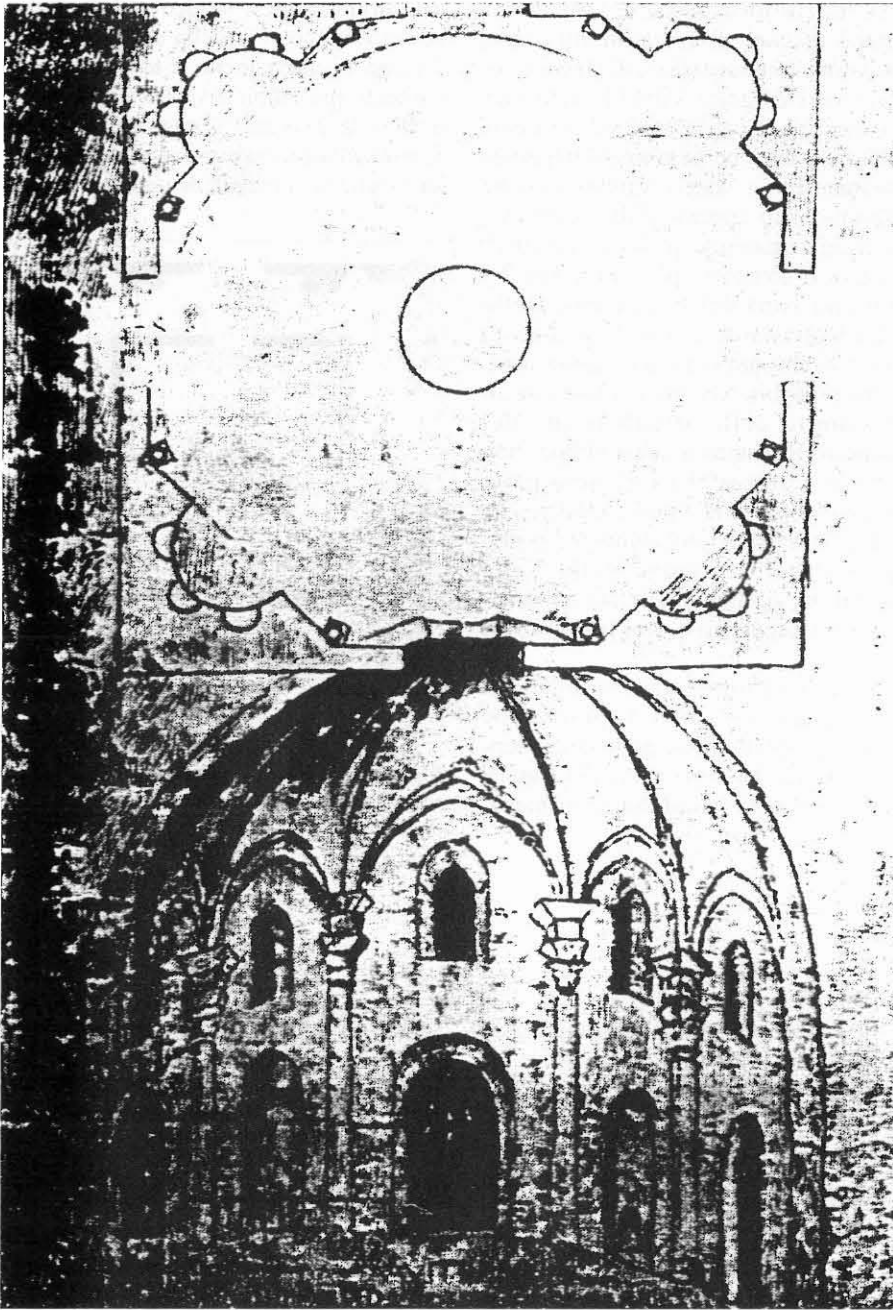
Terme del Bacucco. Pianta e spaccato di Giuliano da Sangallo
